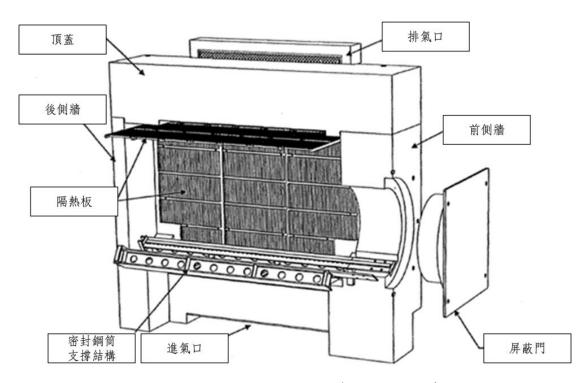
混凝土模組型式熱移除示意圖
